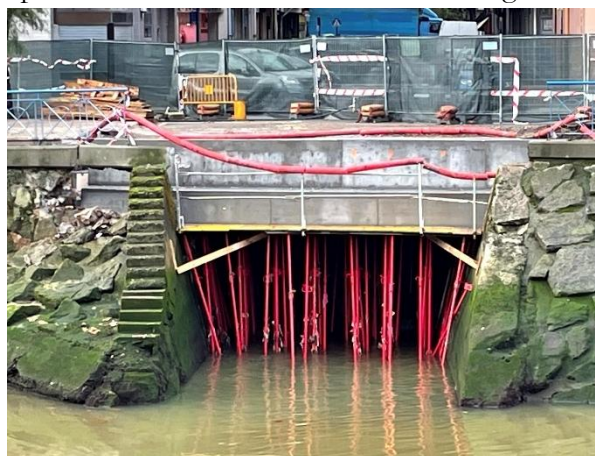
Estribo hormigonado de la margen izquierda sobre la desembocadura de la regata.
